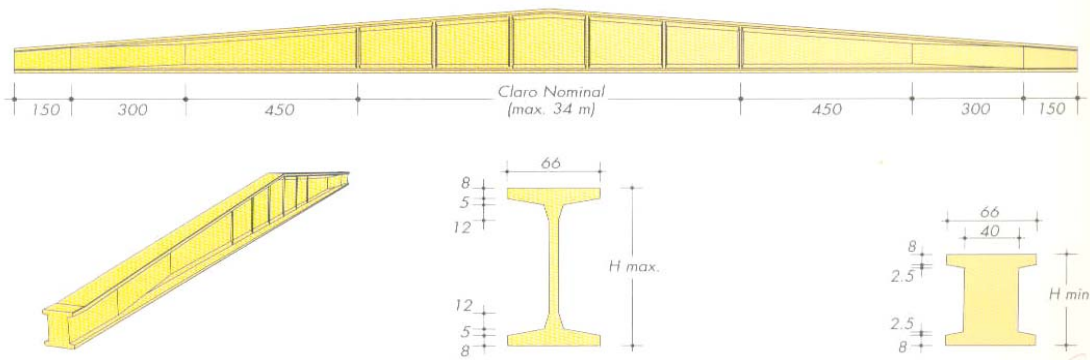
Geometría de viga Delta de concreto presforzado
